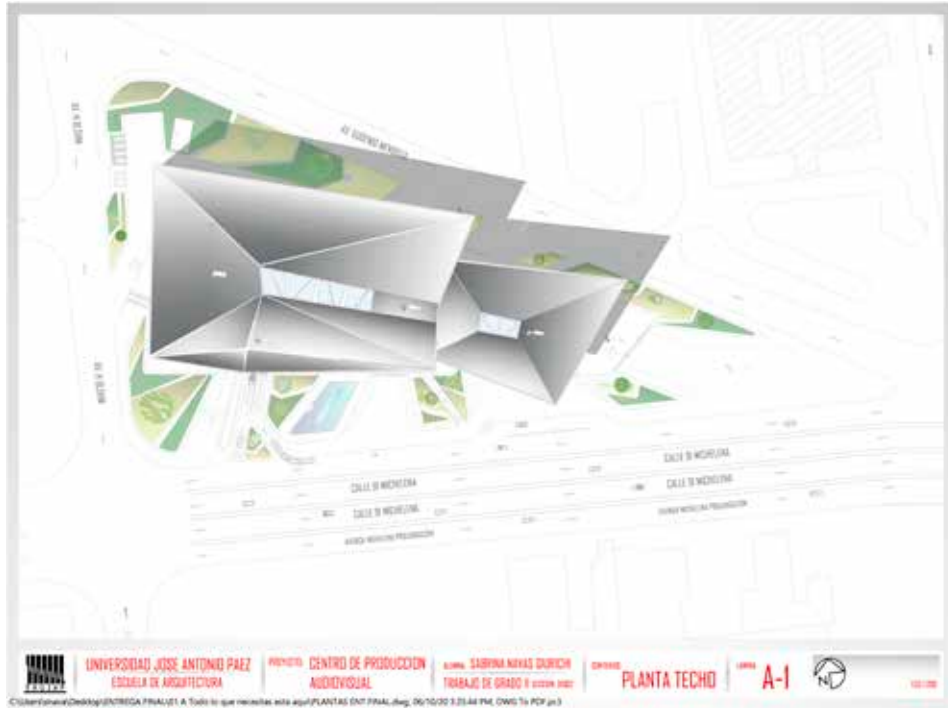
A1. Planta Conjunto. Fuente: Navas. (2020)
